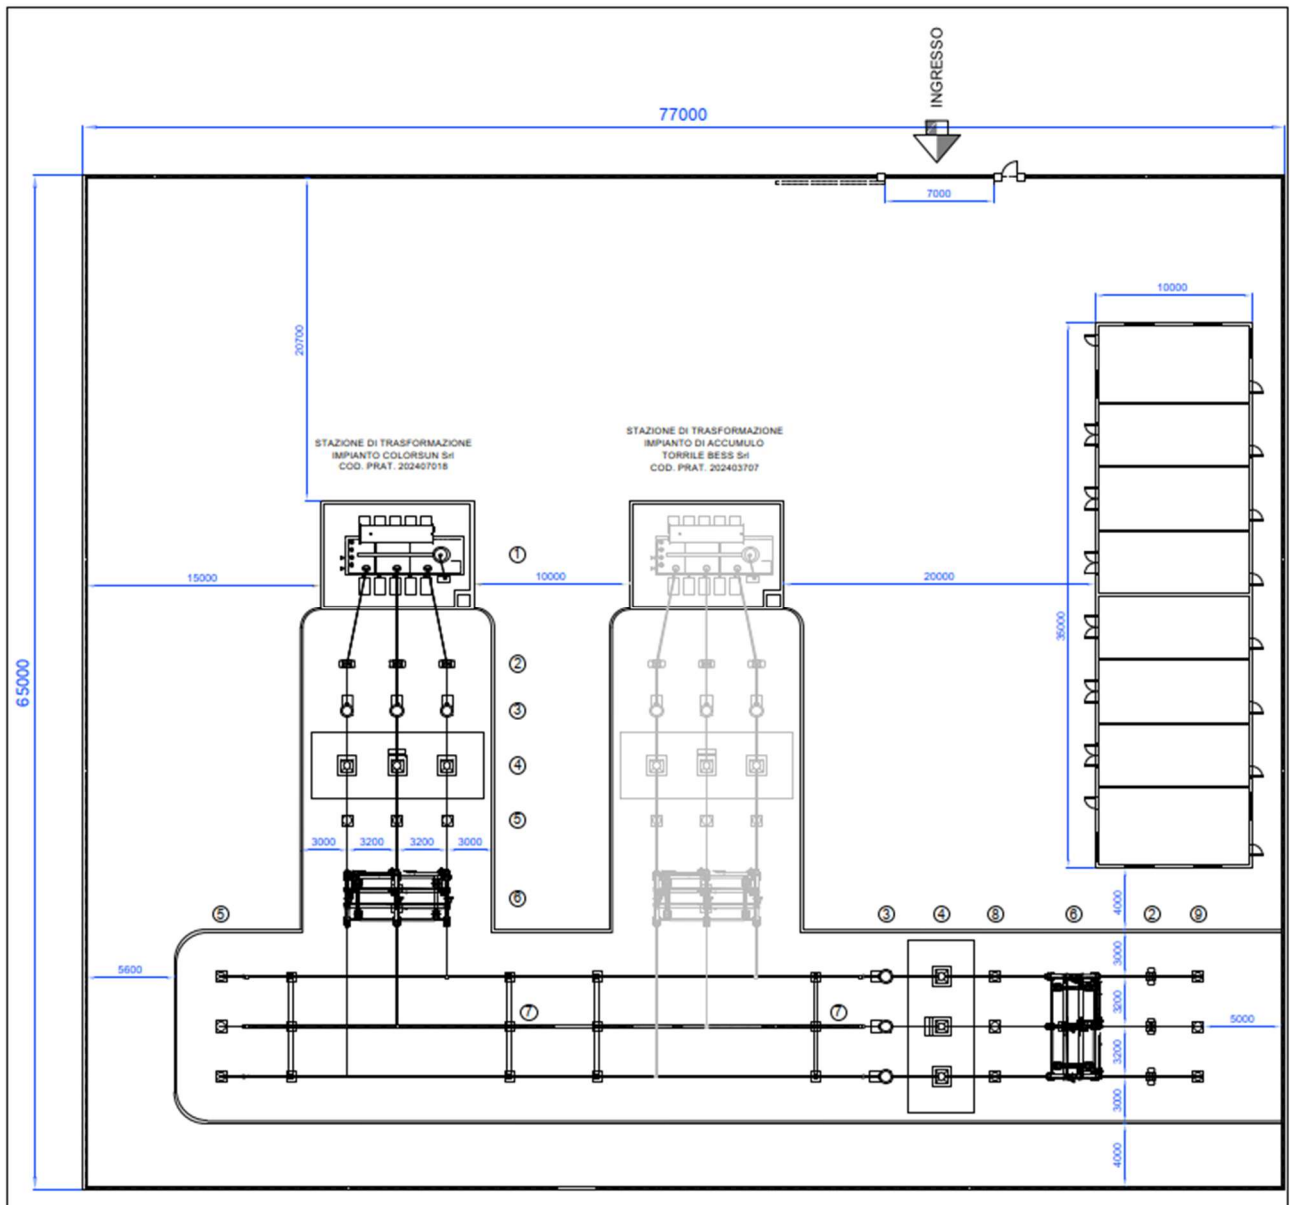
Planimetria elettromeccanica Stazione Elettrica Condivisa
